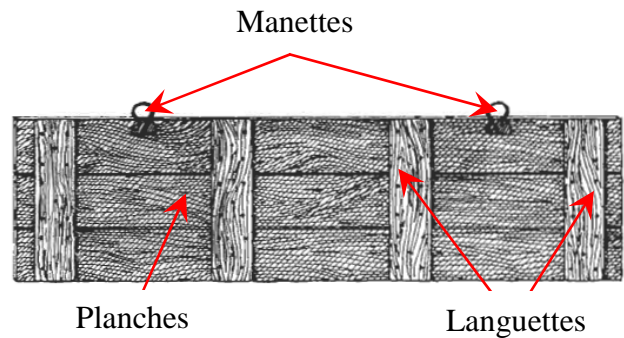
Coffrage traditionnel (Source : Architecture Traditionnelle Méditerranéenne).
